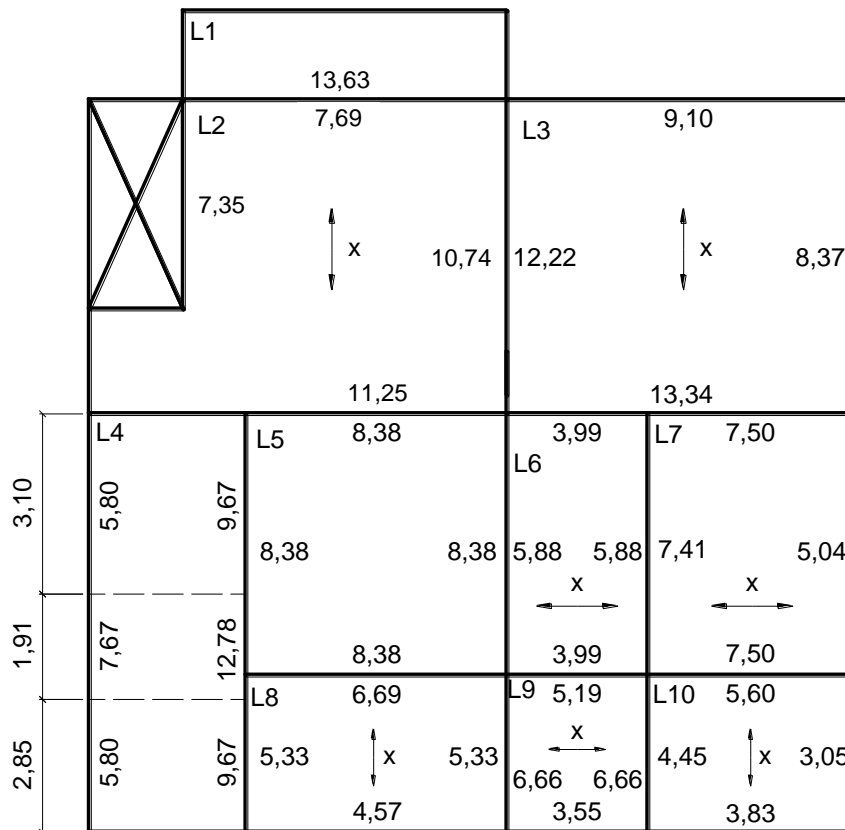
Reações de apoio características (V_k - kN/m) das lajes nas vigas de borda.
